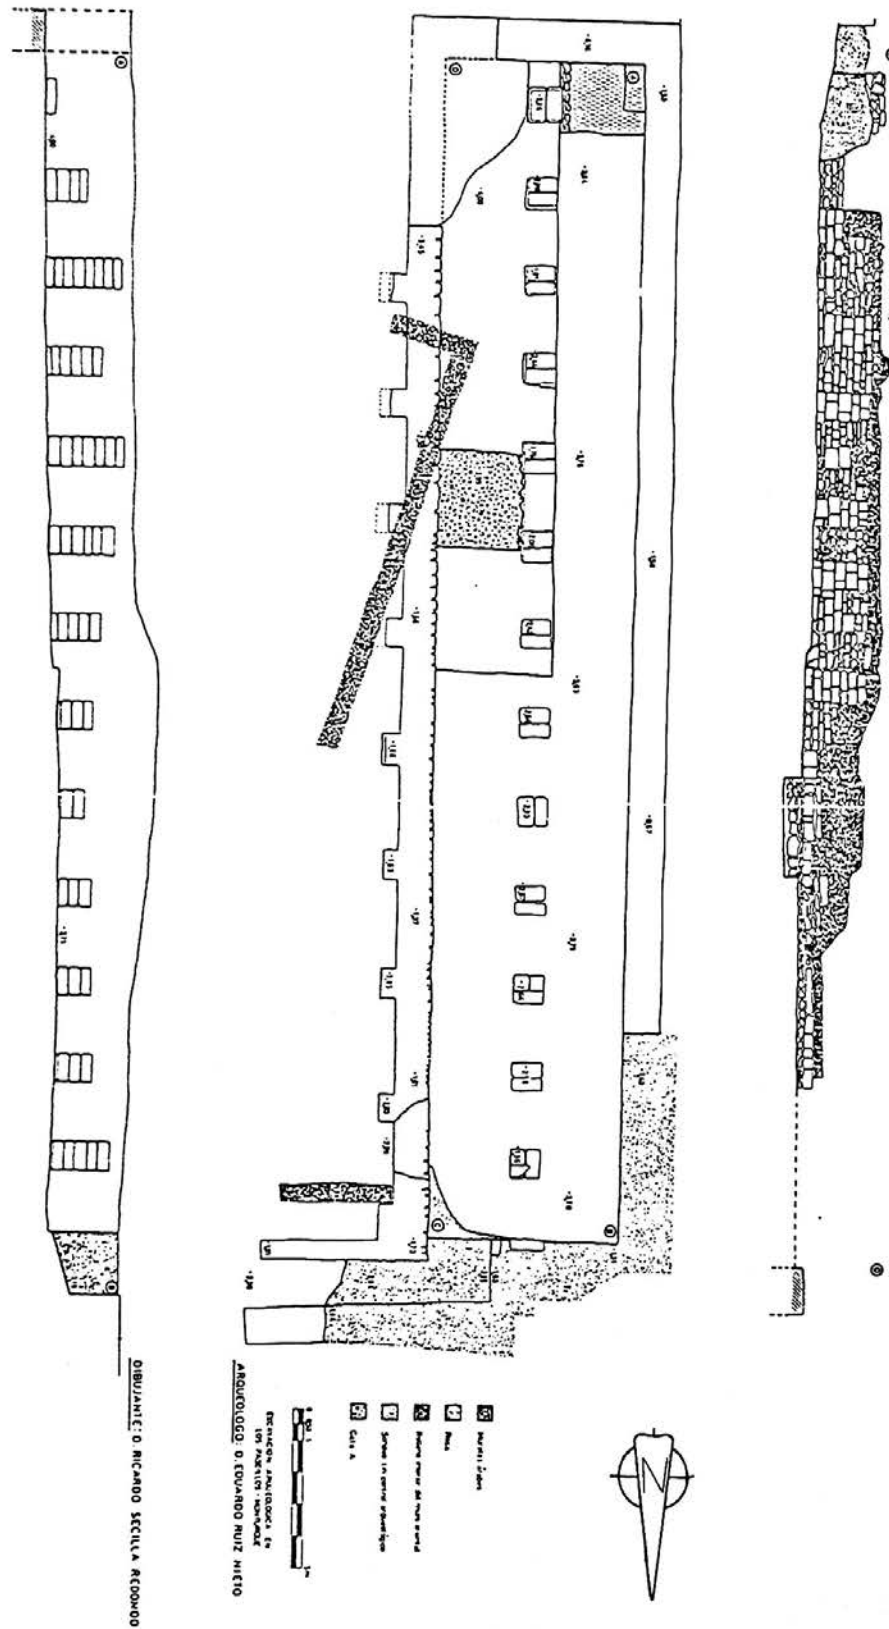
Monturque. Criptopórtico: alzado del paramento interior del muro oriental, planta general y alzado de los pilares. —Según E. Ruiz Nieto (1991).
